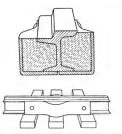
Umgossener Stoss der Milwaukee Rait Joint & Welding Co.
